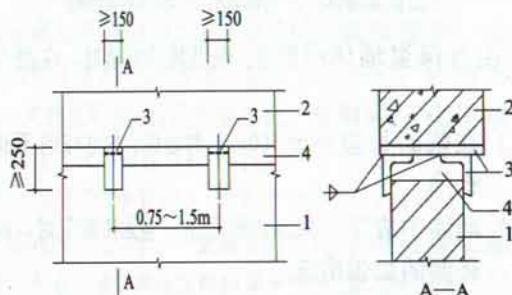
墙体与钢筋混凝土框架梁的金属构件连接构造
